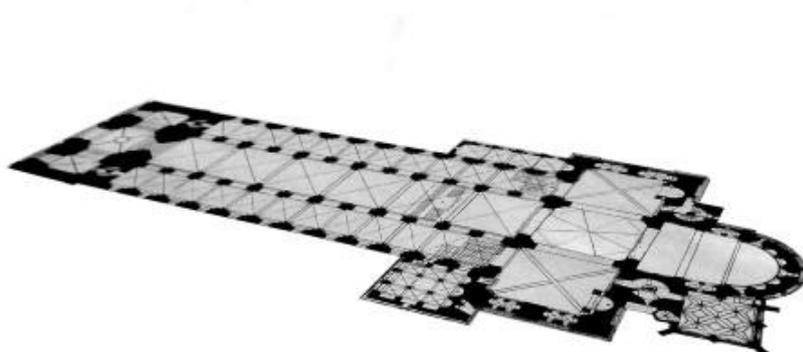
Der Kaiserdom zu Speyer, Ansicht von SO mit Grundriss
